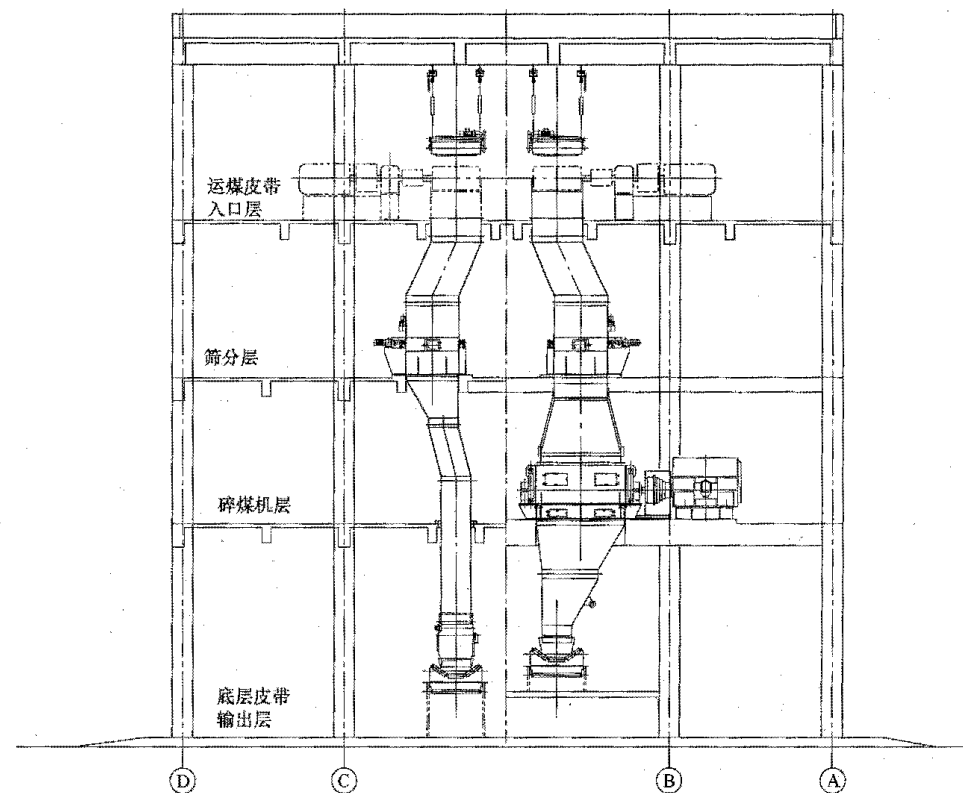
碎煤机垂直于皮带的平面布置图 (二)
